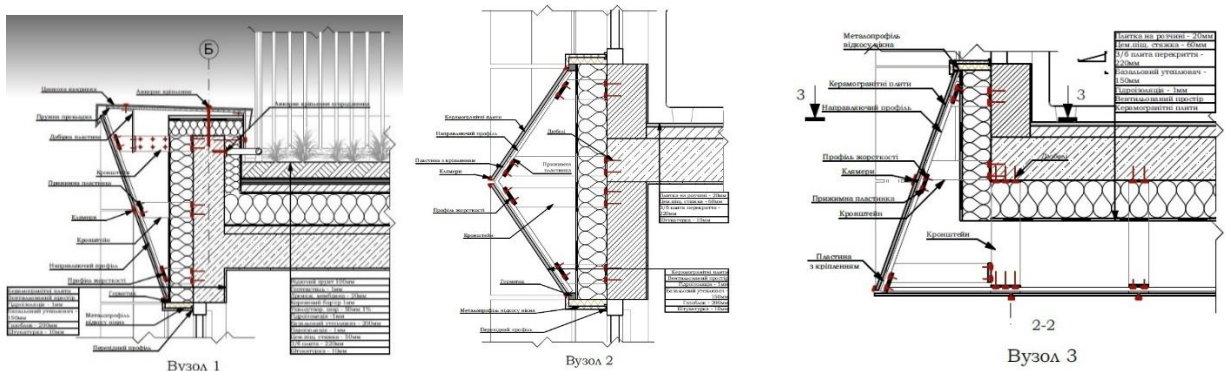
Вузли до фрагменту порталного навісного фасаду.
